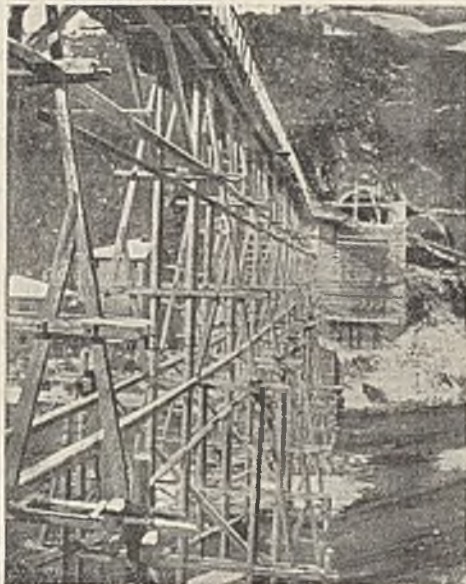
Widerlager beim Südportal des Tunnels Pian di Setta.
